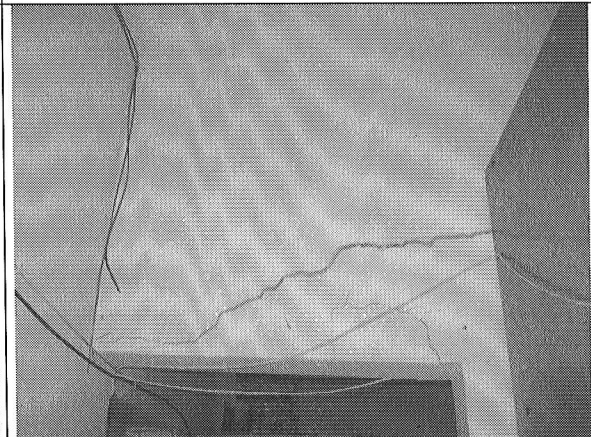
Grietas en muros internos del segundo piso.
